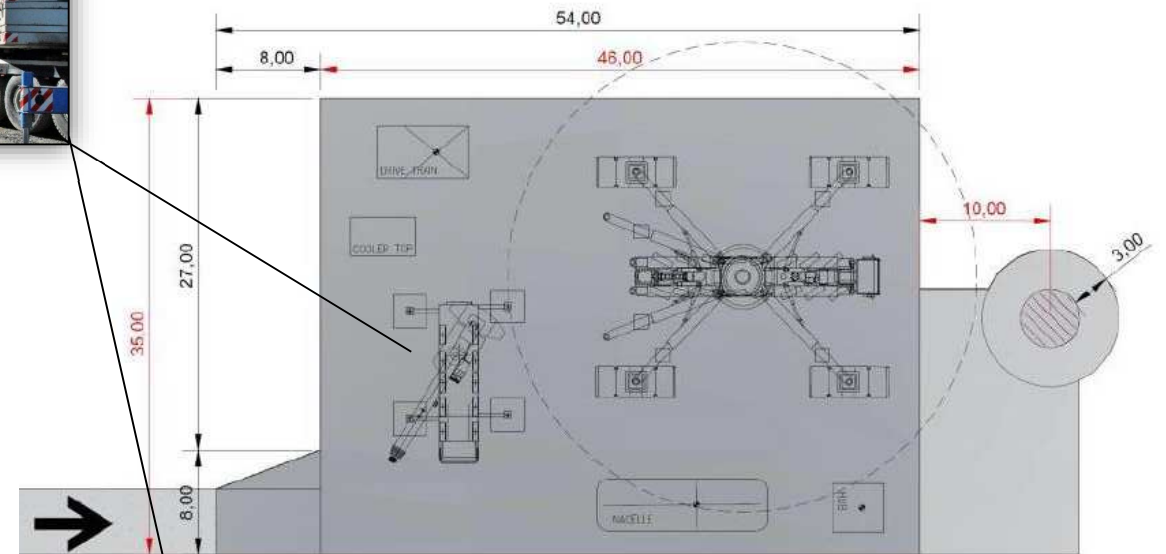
Schéma type de la configuration bout de piste (E1 et E4)
